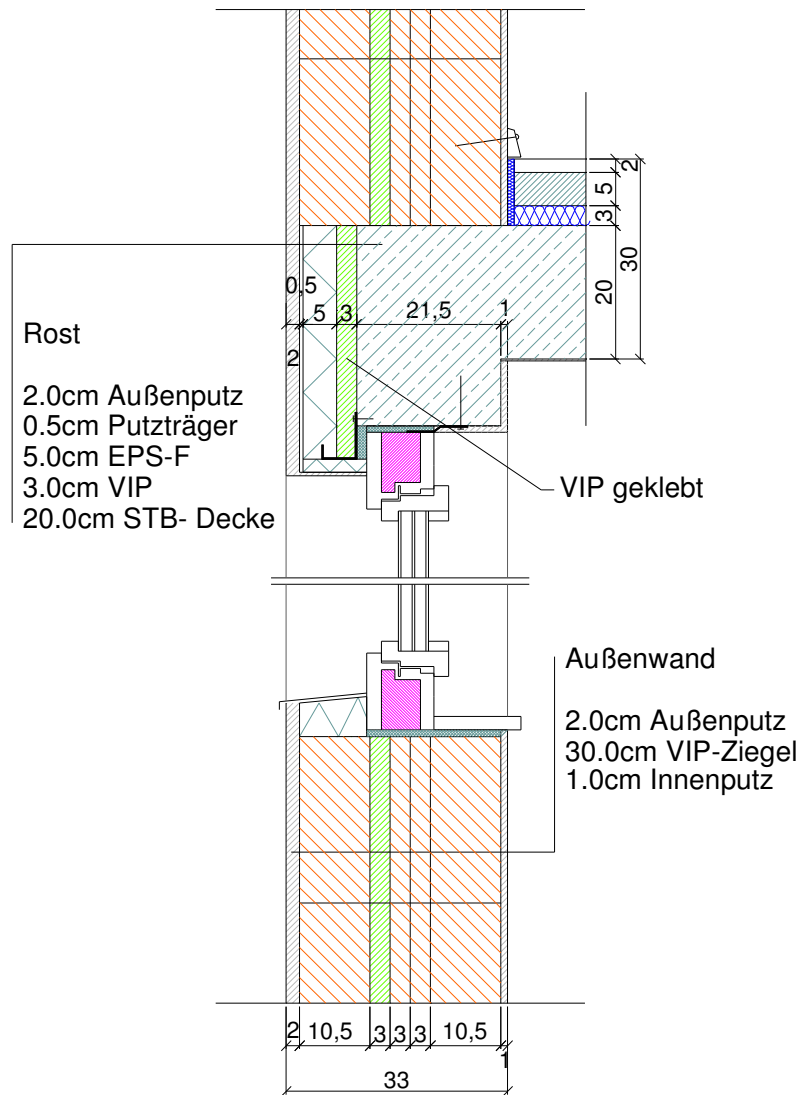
Detail – Fensteranschluss Sturz, Parapet [eigene Abb.]
